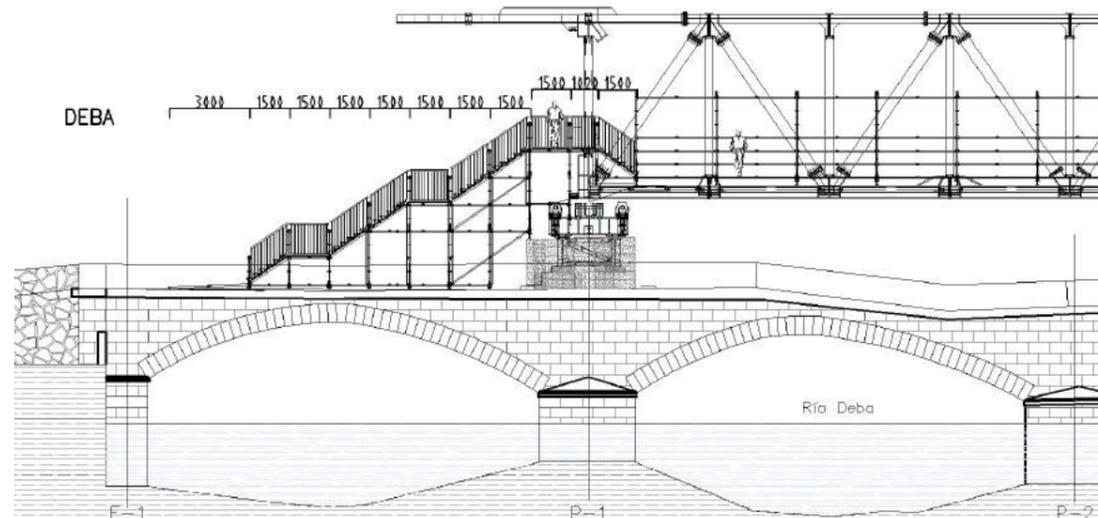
Alzado de las escaleras de acceso a la pasarela provisional desde el lado de Deba. En cuanto al acceso desde el lado de Mutriku, éste presenta un desarrollo en planta en forma de L, con el fin de invadir el menor espacio posible de vía inferior, tal y como se puede observar en la imagen inferior.
